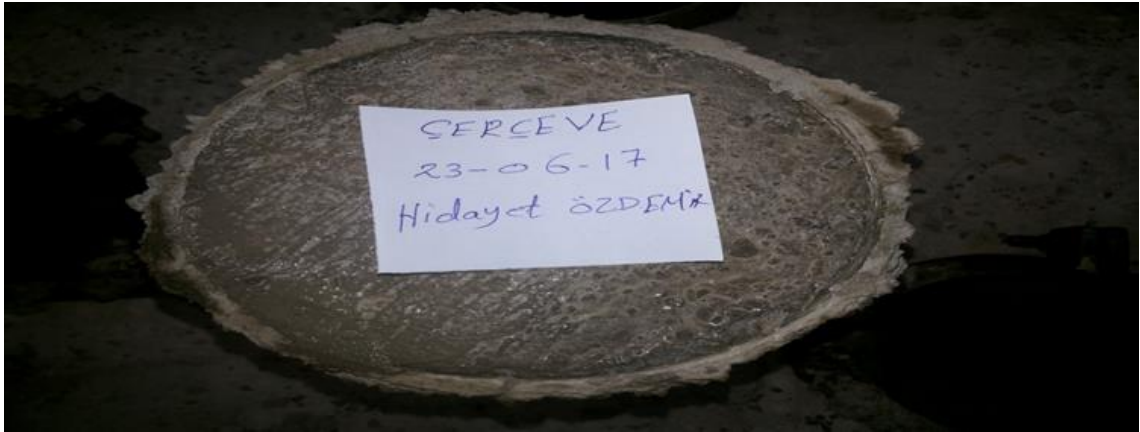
Beton dökümü tamamlanmış çerçeveler
